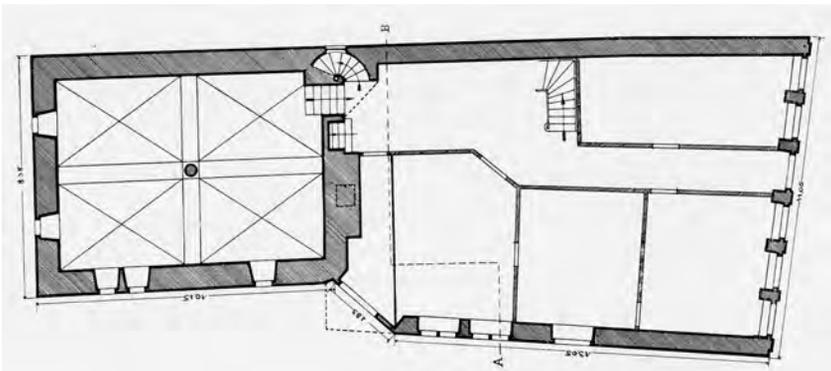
Das Haus des Bürgermeisters Vendt, Aegidiistraße 62, Grundriss des Erdgeschosses
